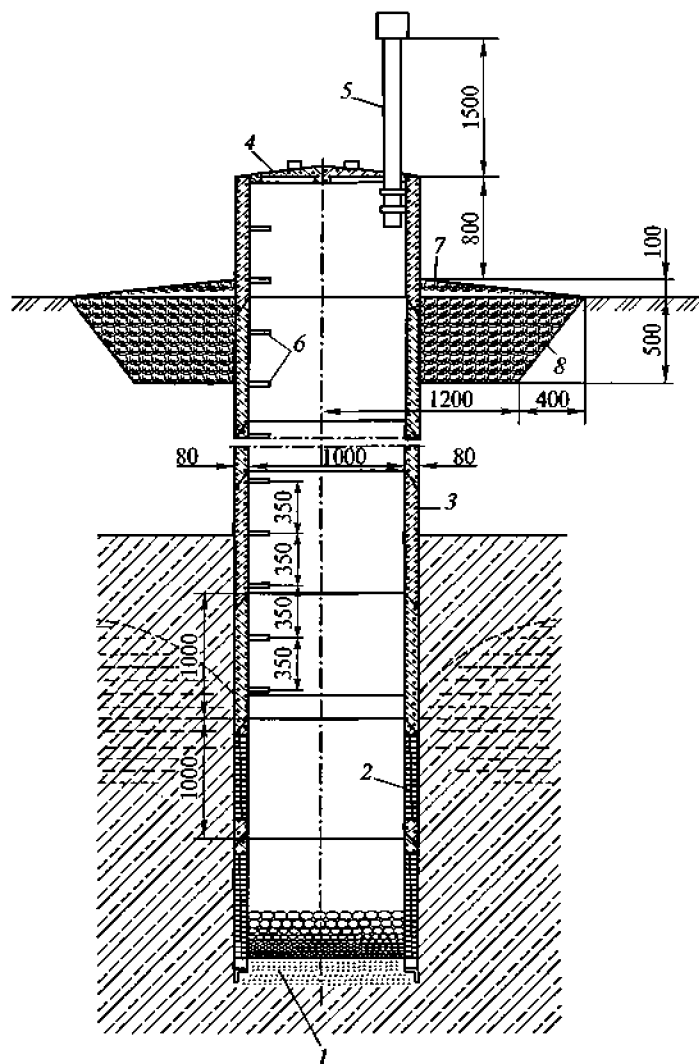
Общий вид шахтного колодца из железобетонных колец:
